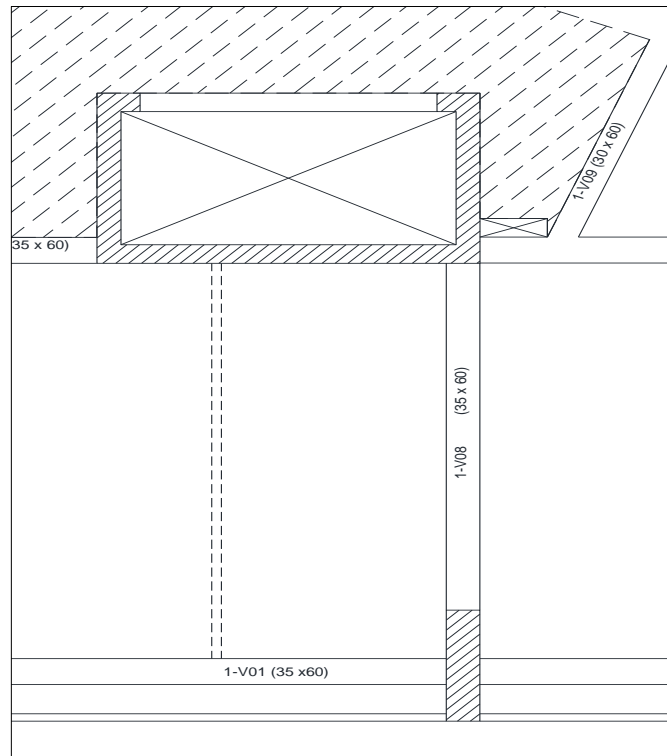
Planta de encofrado - tramos de vigas a diseñar.
